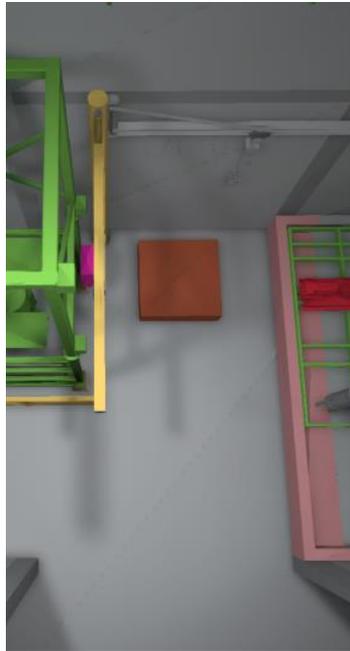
Vista 3D de Zona de pesaje y tableros.
